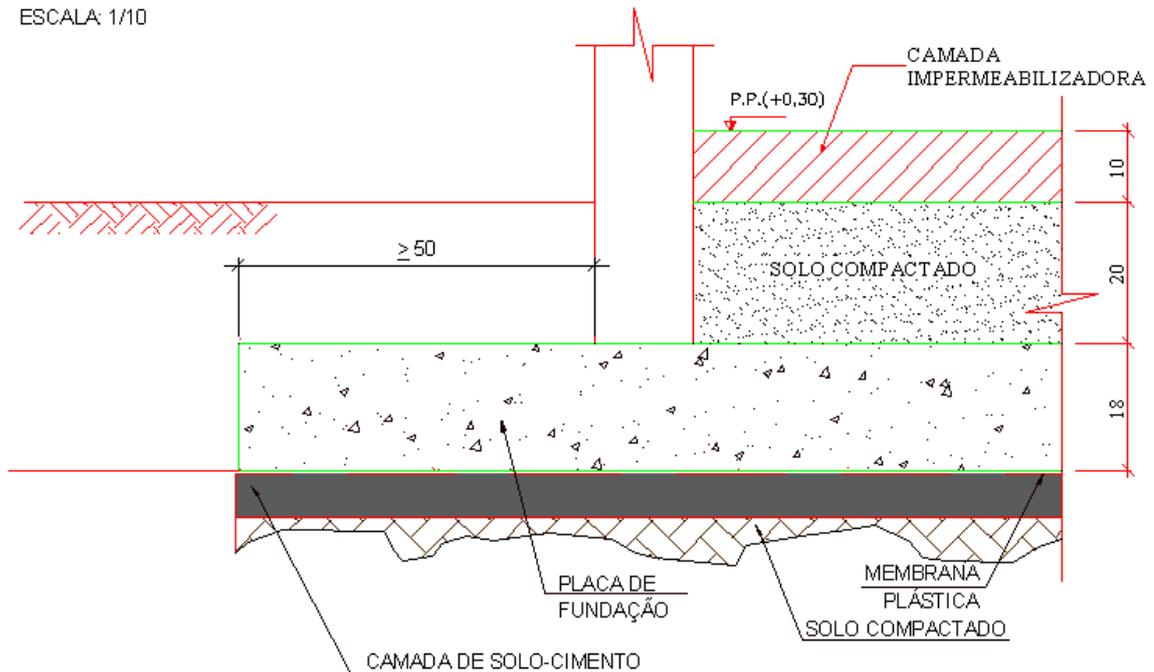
Detalhamento final das estacas de melhoria do solo mais os elementos constituintes da fundação radier.
